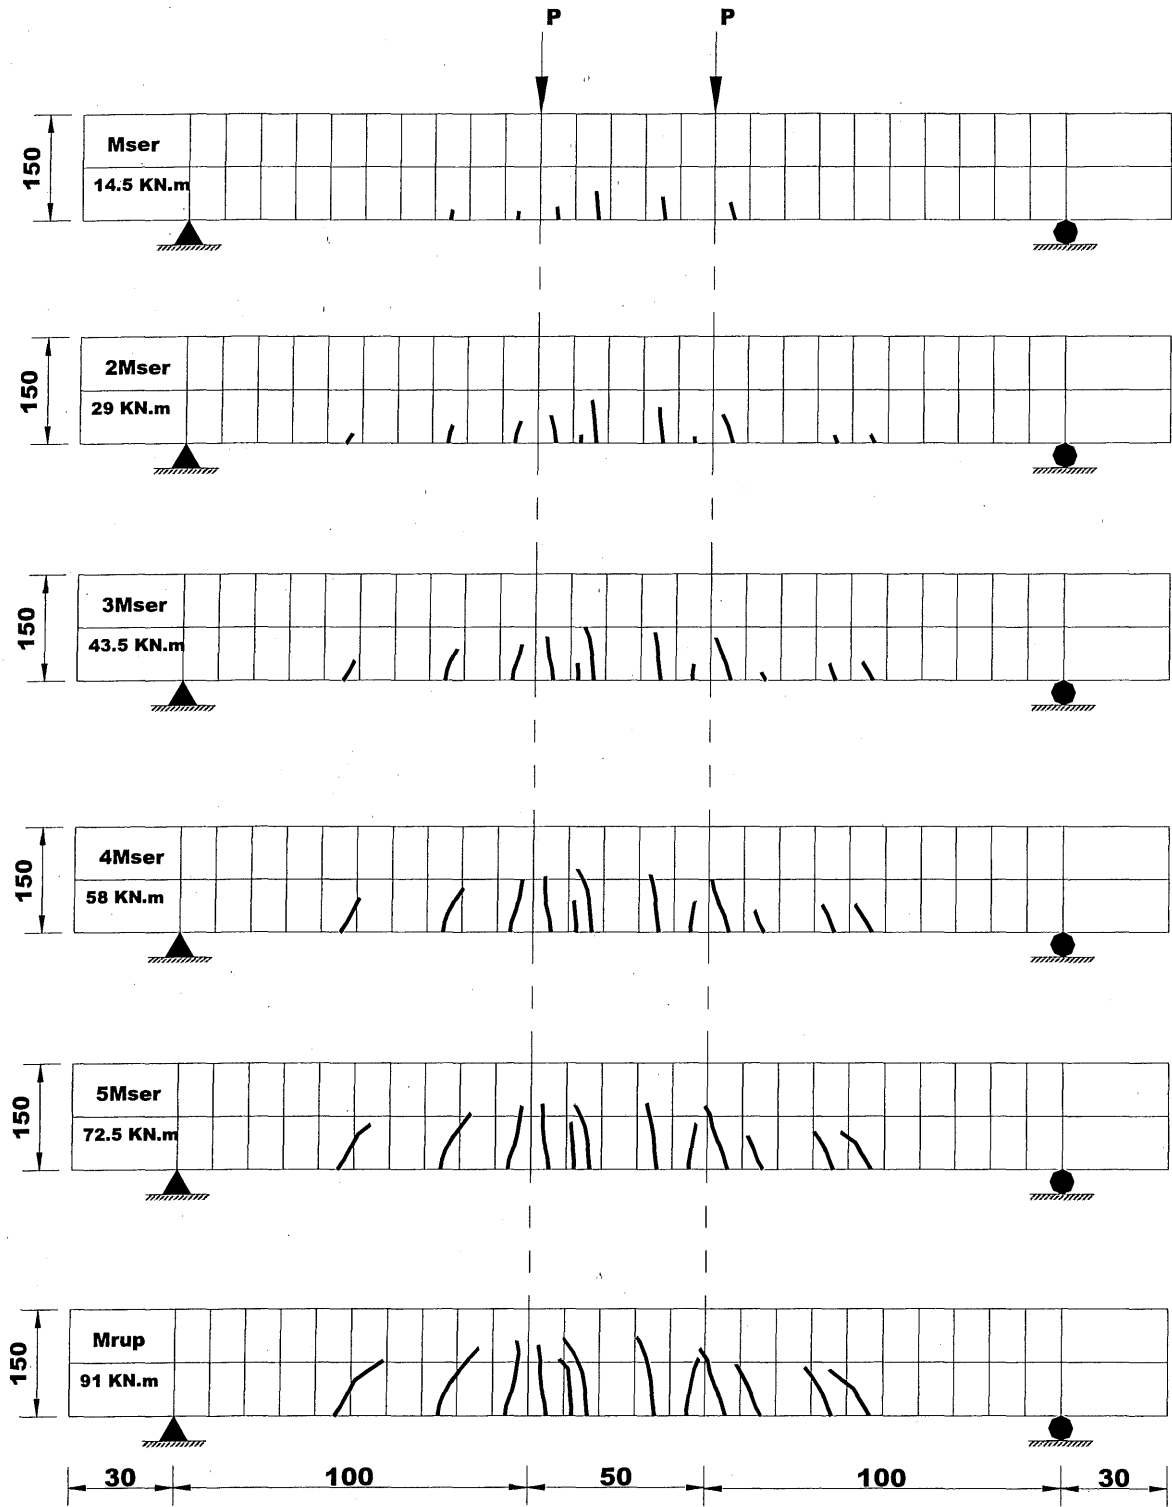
Propagation des fissures au niveau dalle S-GGI
